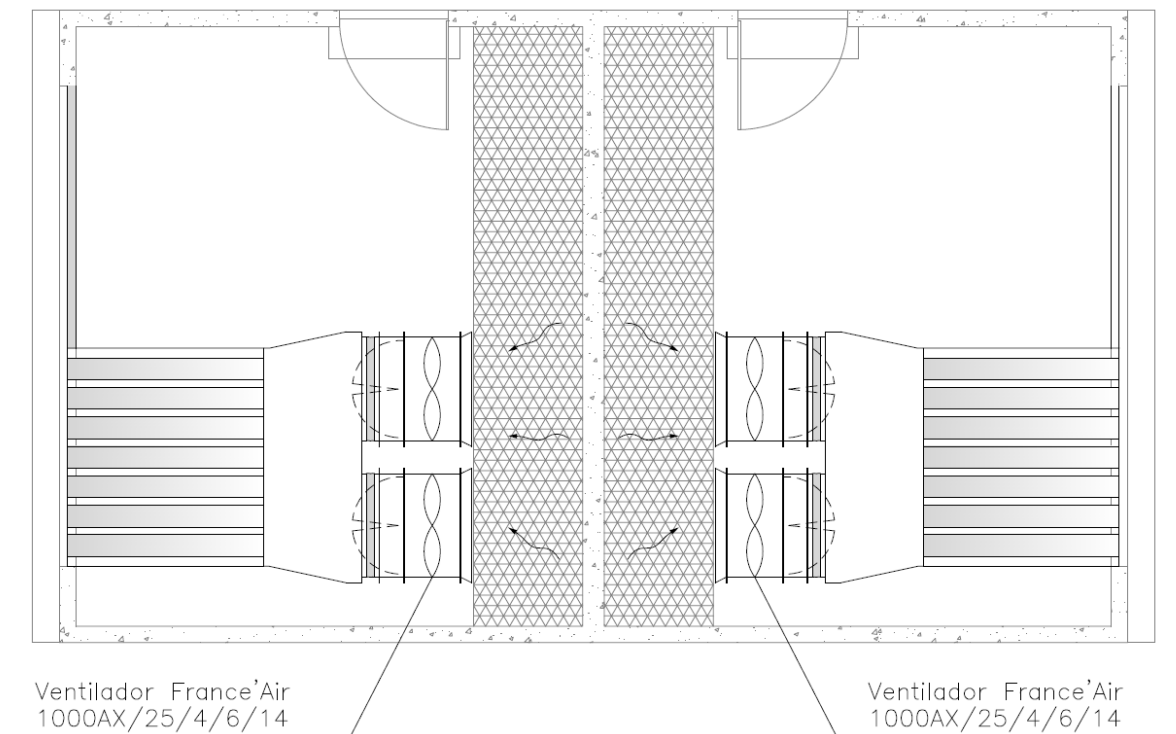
Planta das áreas abrangidas do sistema de ventilação – Edifício de Comando
